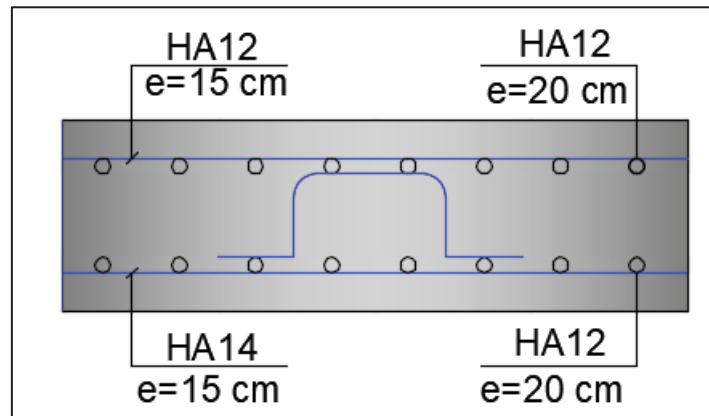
Ferrailage de la dalle (coupe transversale).
